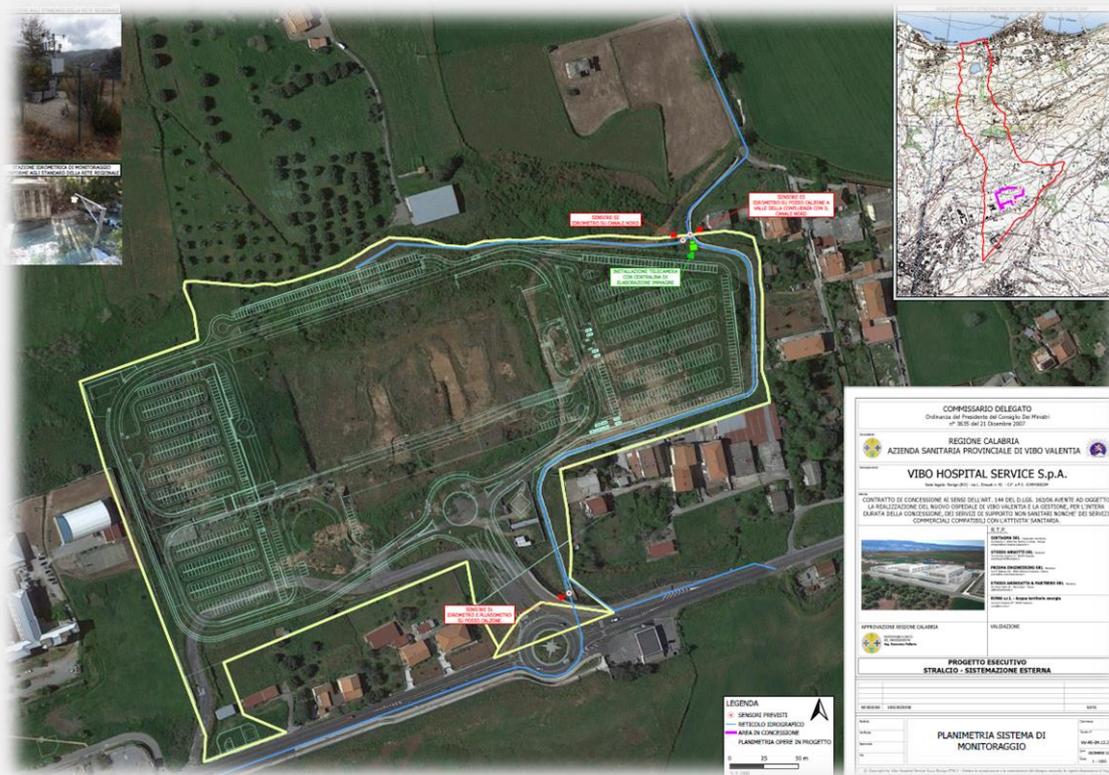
Planimetria del sistema di monitoraggio previsto sul cantiere del nuovo Ospedale di Vibo Valentia (fonte: "Progetto Esecutivo" dell'opera)
